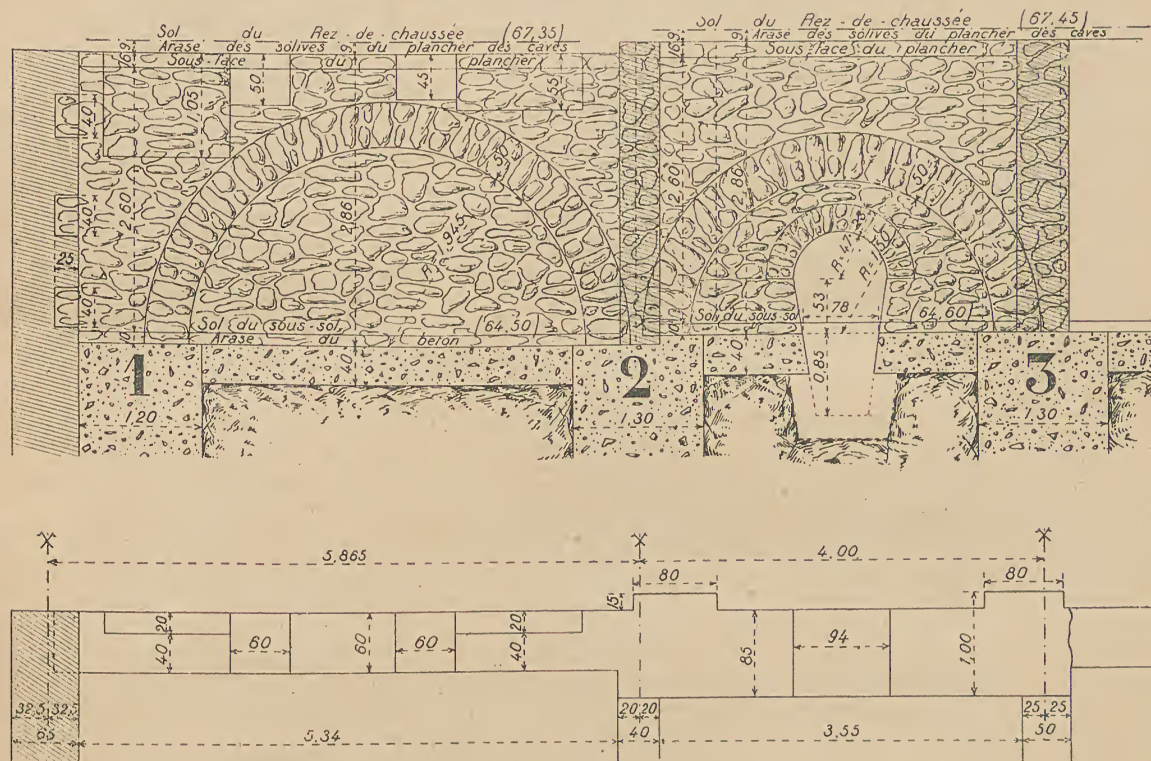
et 7. — Élévation et plan du mur de cave en façade sur le boulevard, sous la boutique de droite et la porte d'entrée.
